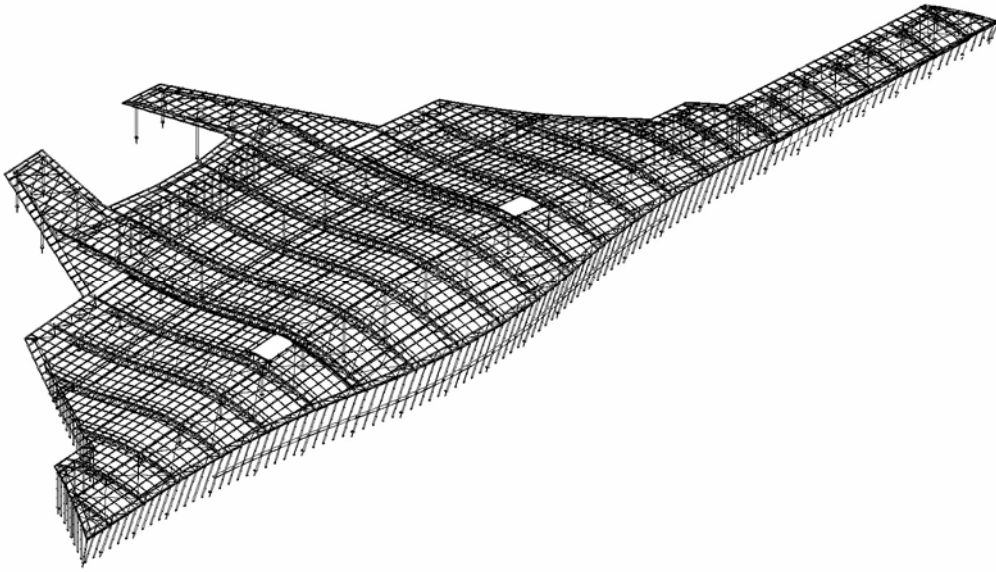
Perspective de la charpente métallique vue du côté piste
